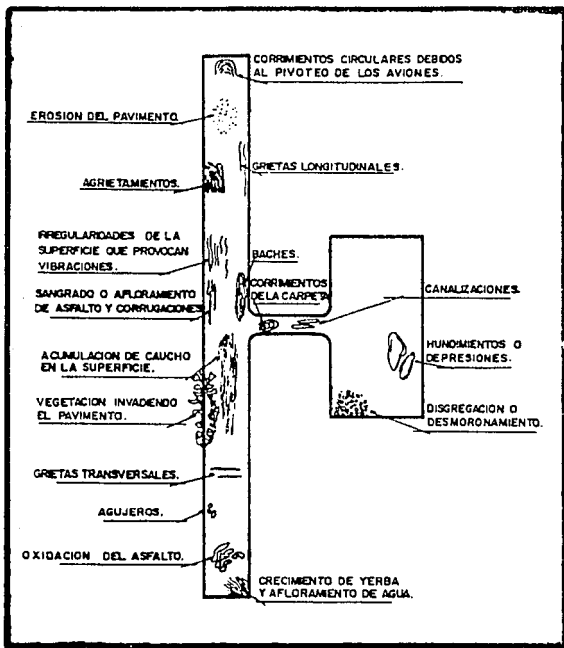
FALLAS COMUNES EN PAVIMENTOS FLEXIBLES DE USO AERONAUTICO.
